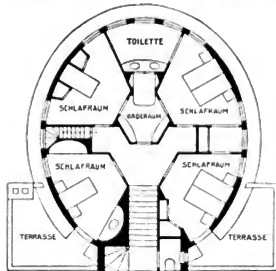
Grundriß vom Obergeschoß des Landhauses.
